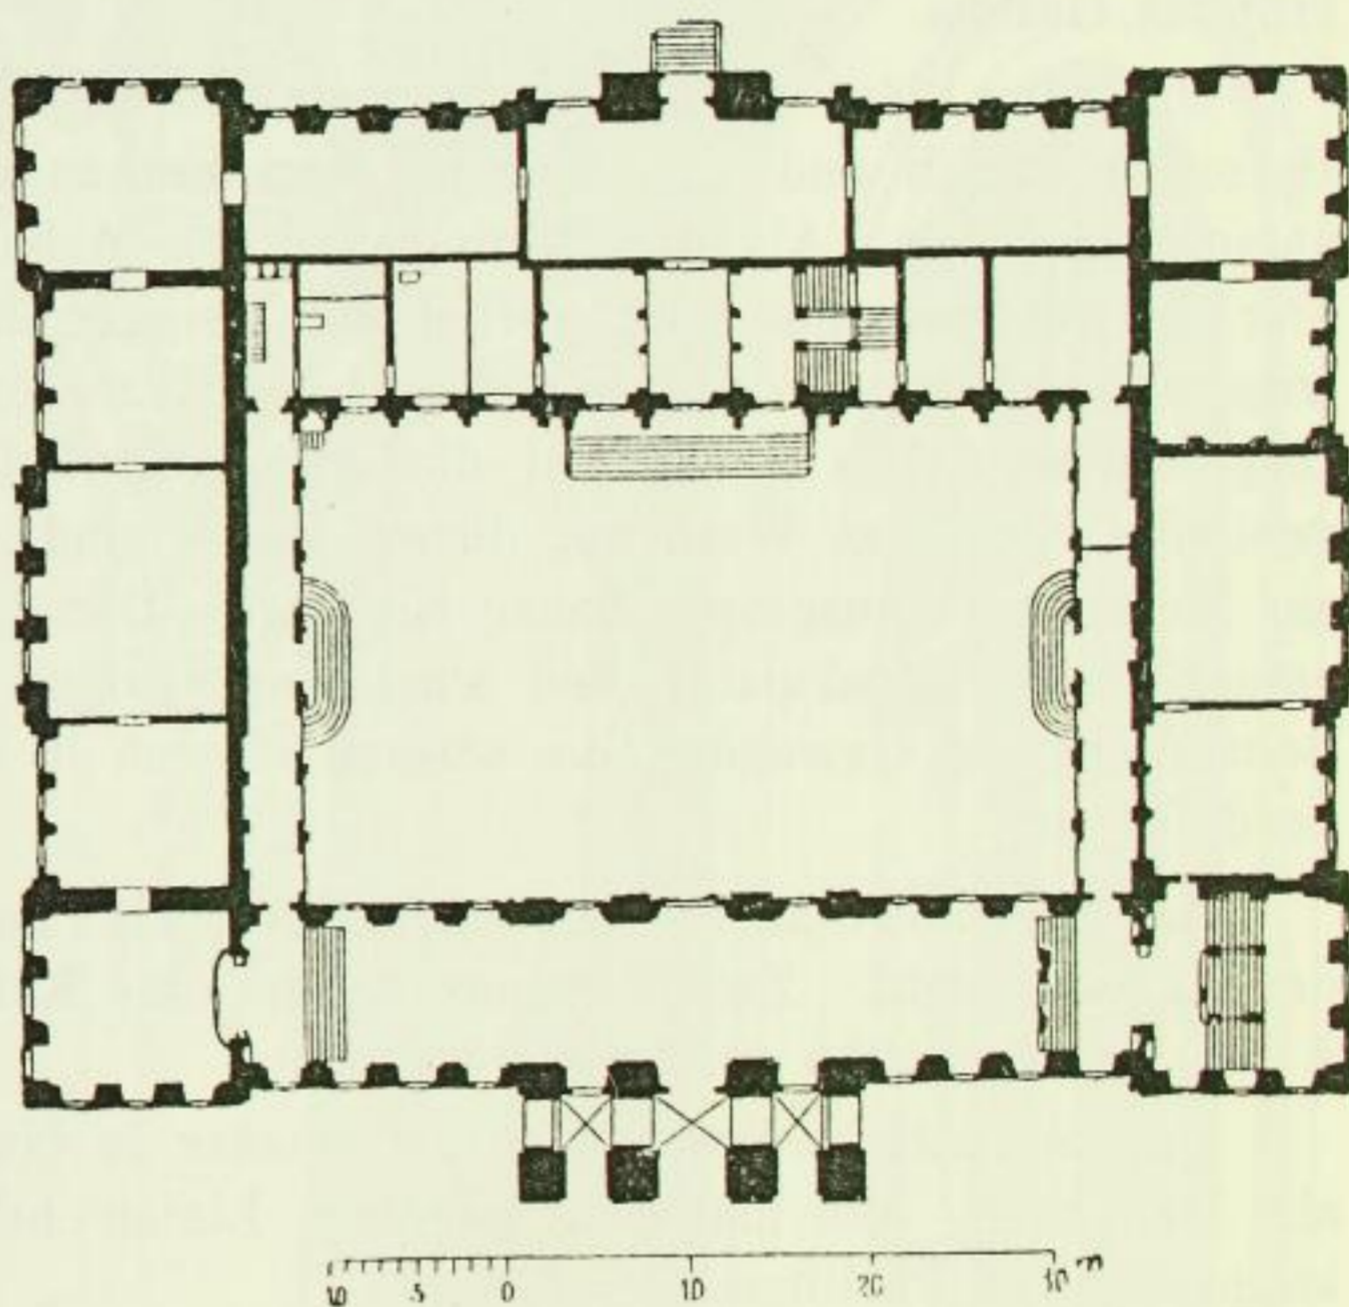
Japanisches Palais. Grundriss des Erdgeschosses.
